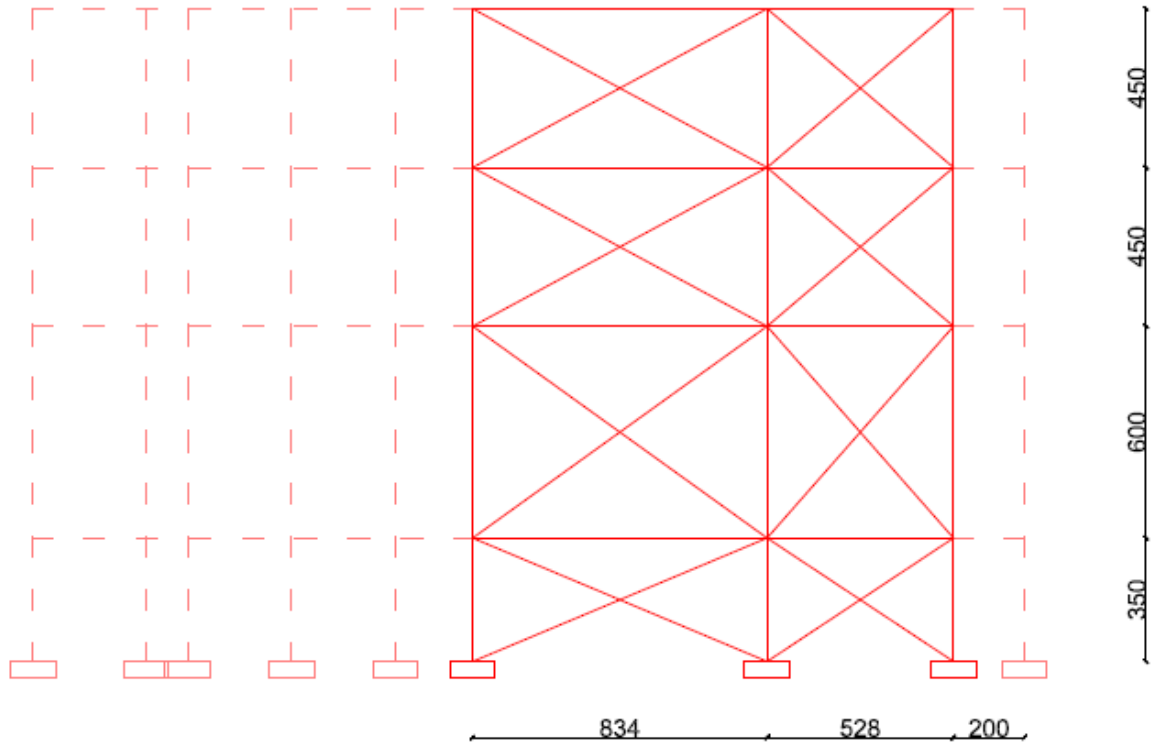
Schema sezione verticale dei controventi 4 e 5
